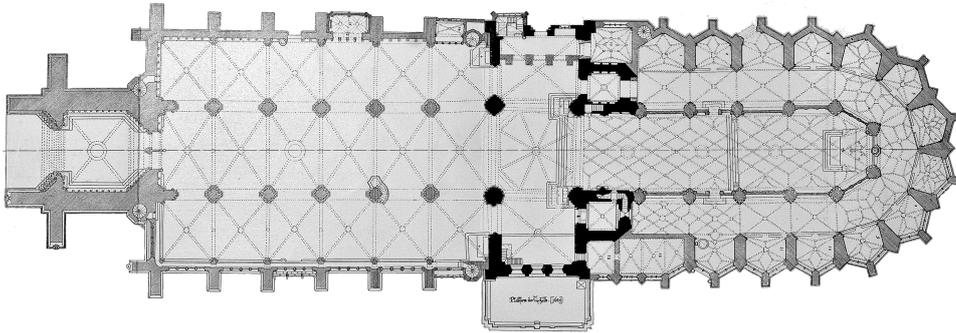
Grundriss des Freiburger Münsters, Quelle: [W]
